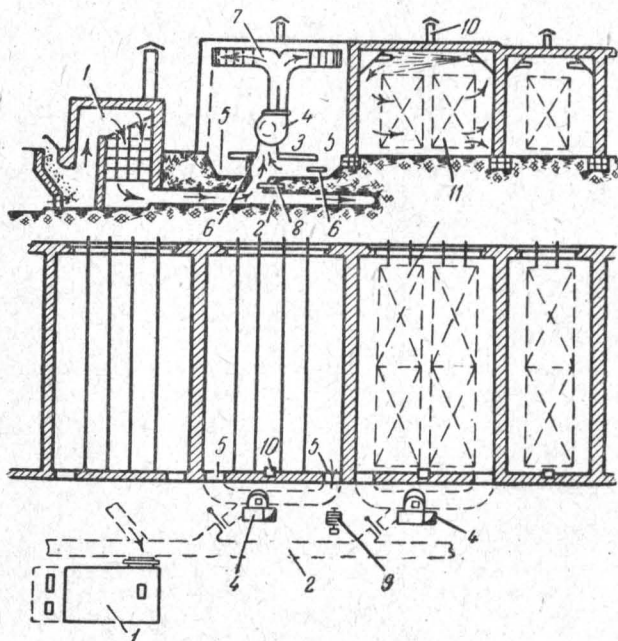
Эжекционно-реверсивная сушилка ЦНИИМОД
